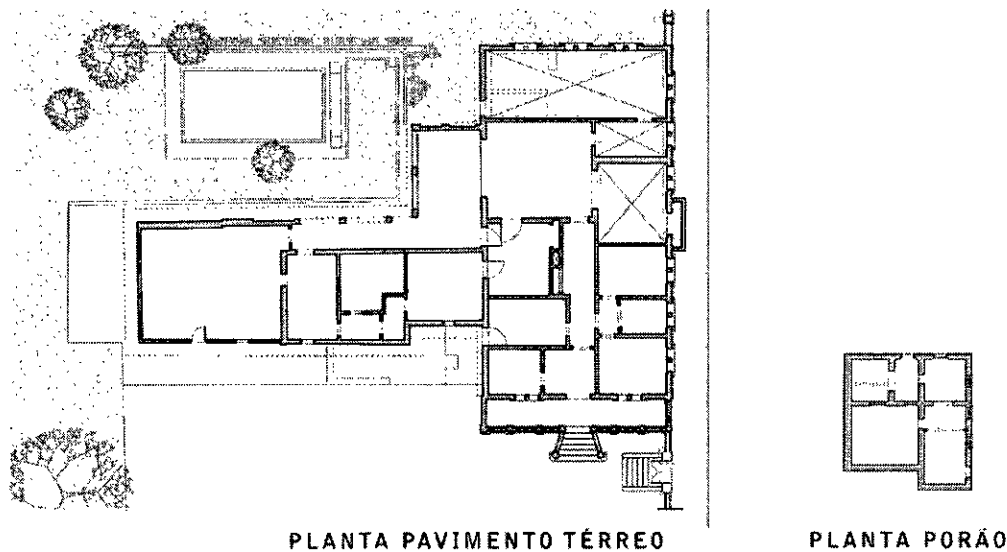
Plantas do pavimento térreo e do porão (sem escala) da “Casa Grande”.
